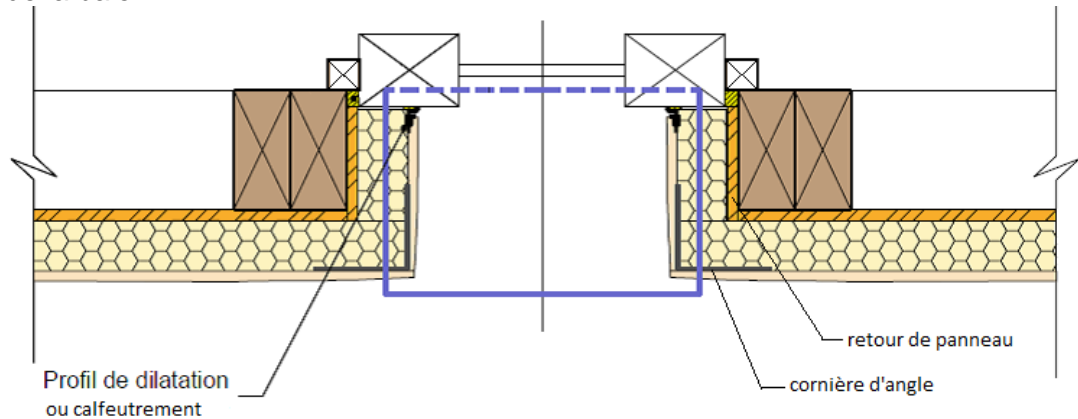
Retour d'enduit en tableau (Ee1) – coupe horizontale
